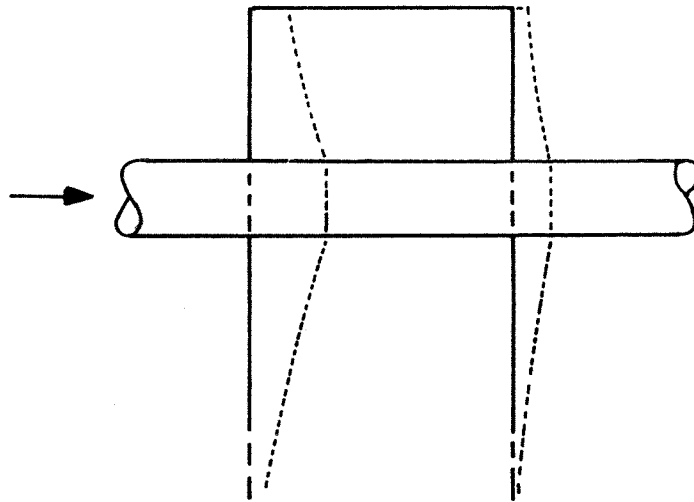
Kraftübertragung durch Haftung von Bewehrungsstahl im Beton:
